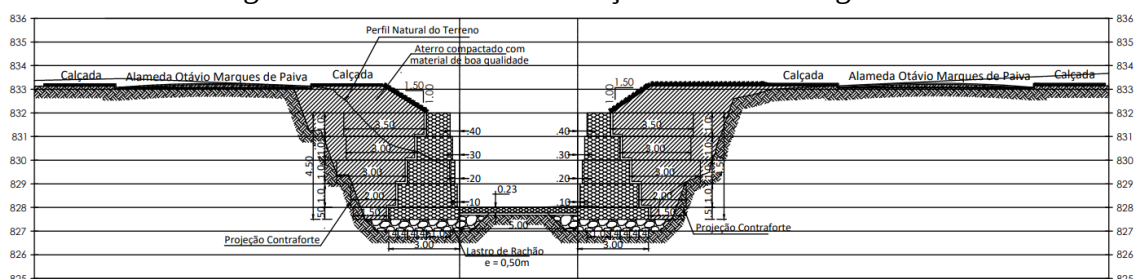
Detalhamento do trecho com aduelas abertas de concreto armado.
